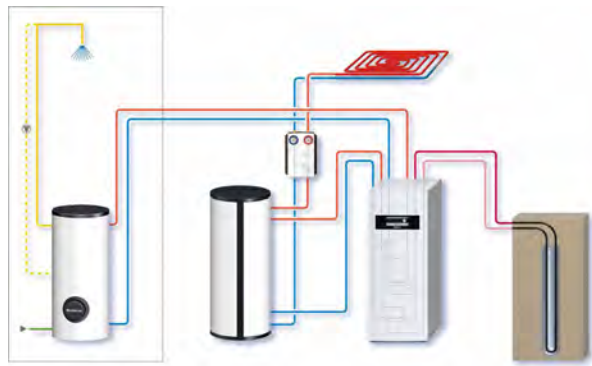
Systembild einer Erdwärmepumpe mit Erdsonde
